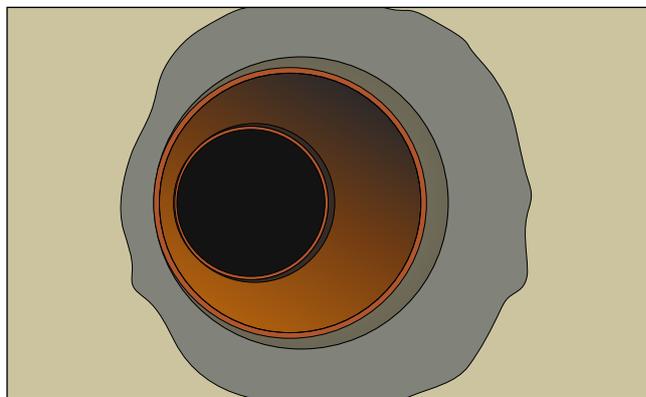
Ilustrações das ligações de ramais em boas condições estruturais (2)
